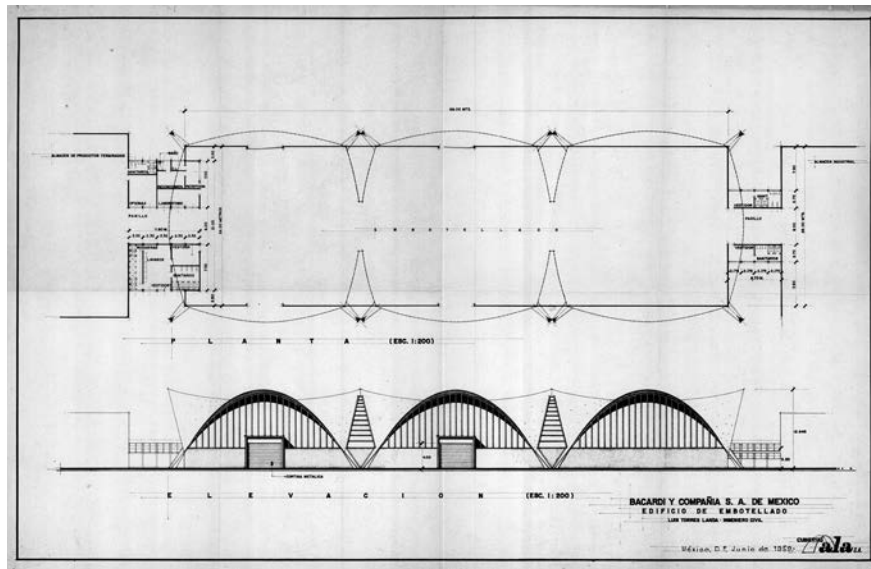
Plano de Planta y Alzado. Embotelladora Bacardí. Cubiertas Ala 1958
